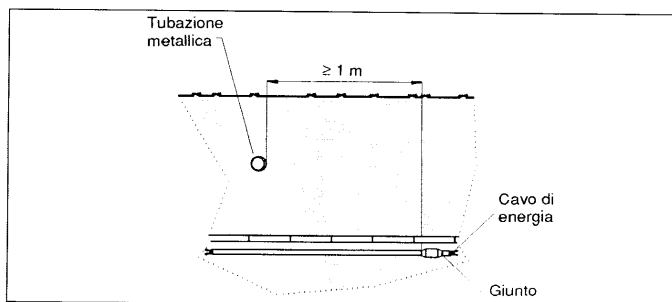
Le connessioni sui cavi devono distare in pianta almeno 1 m dal punto di incrocio con una tubazione metallica.
